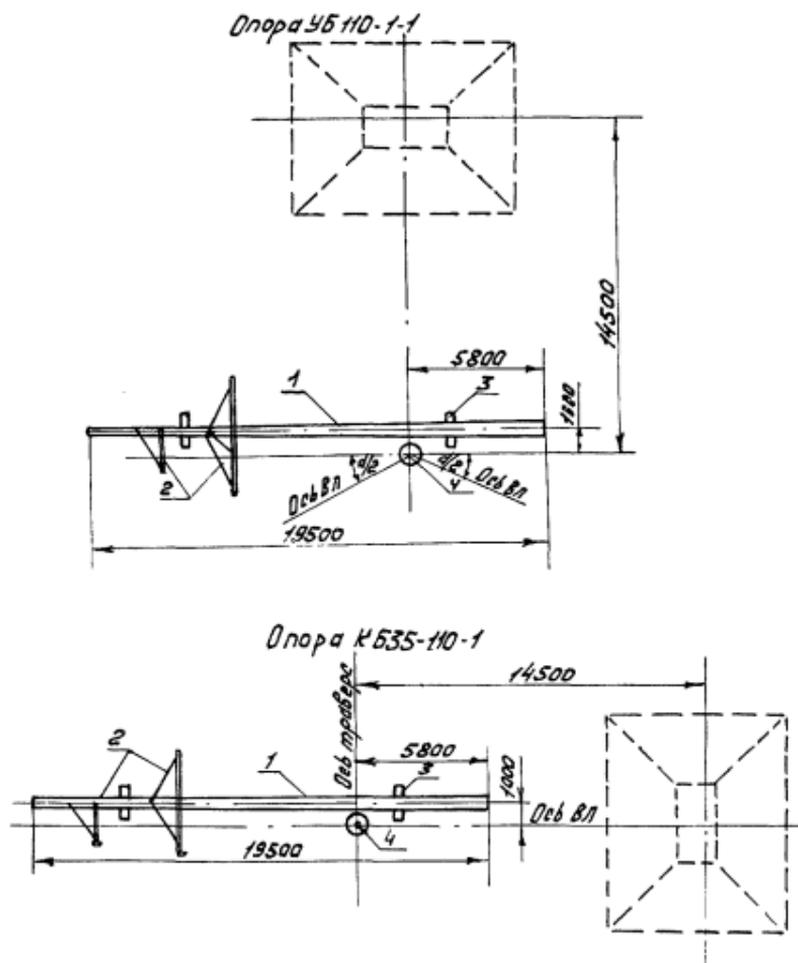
Схема выкладки и сборки опор: УБ 110-1-1; КБ 335-110-1
